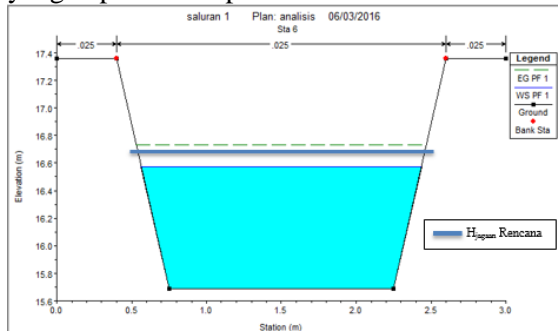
Cross Section profil saluran Sta.4 (J.4) pias I.
